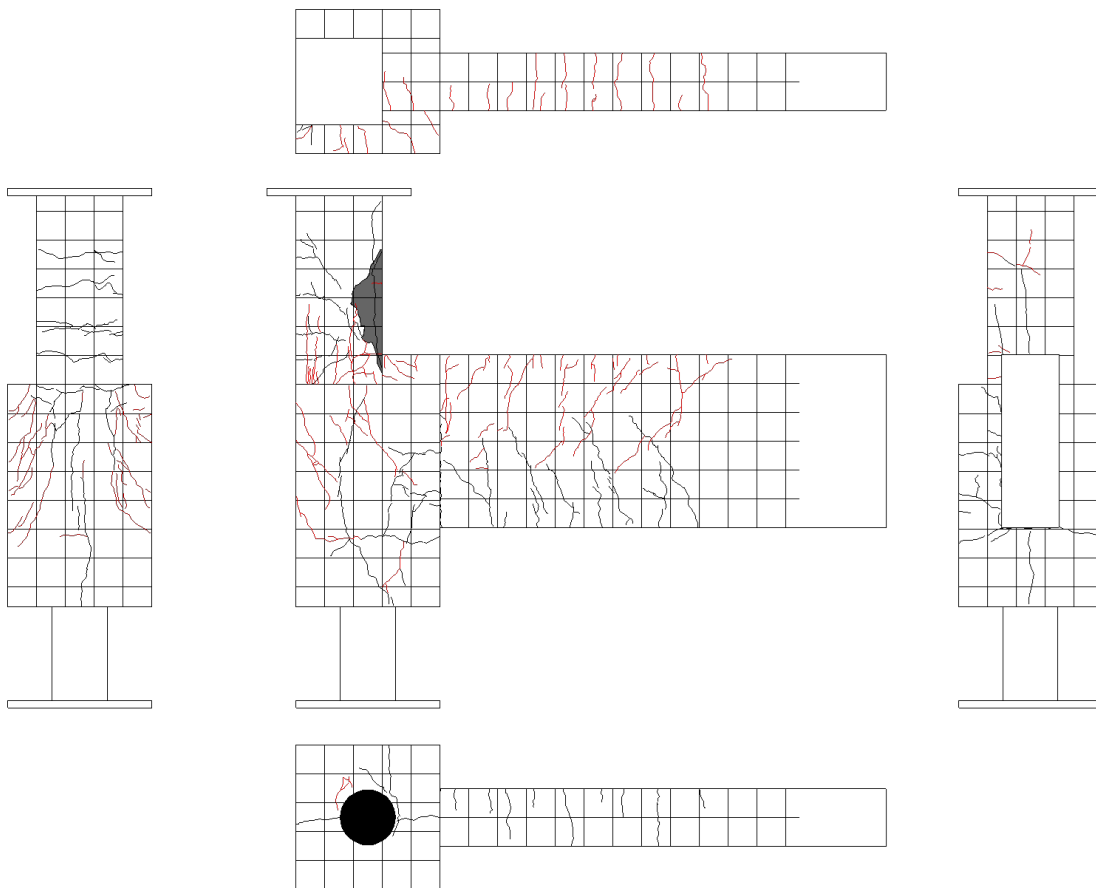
3. 88 試験体 C-1 ひび割れ状況 (5Cycle)
